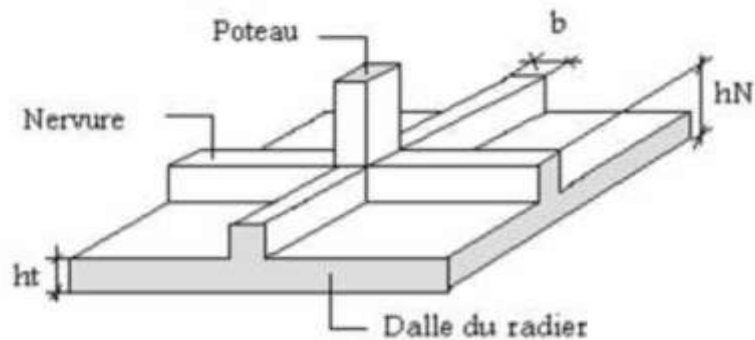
Disposition des nervures par rapport au radier et aux poteaux
